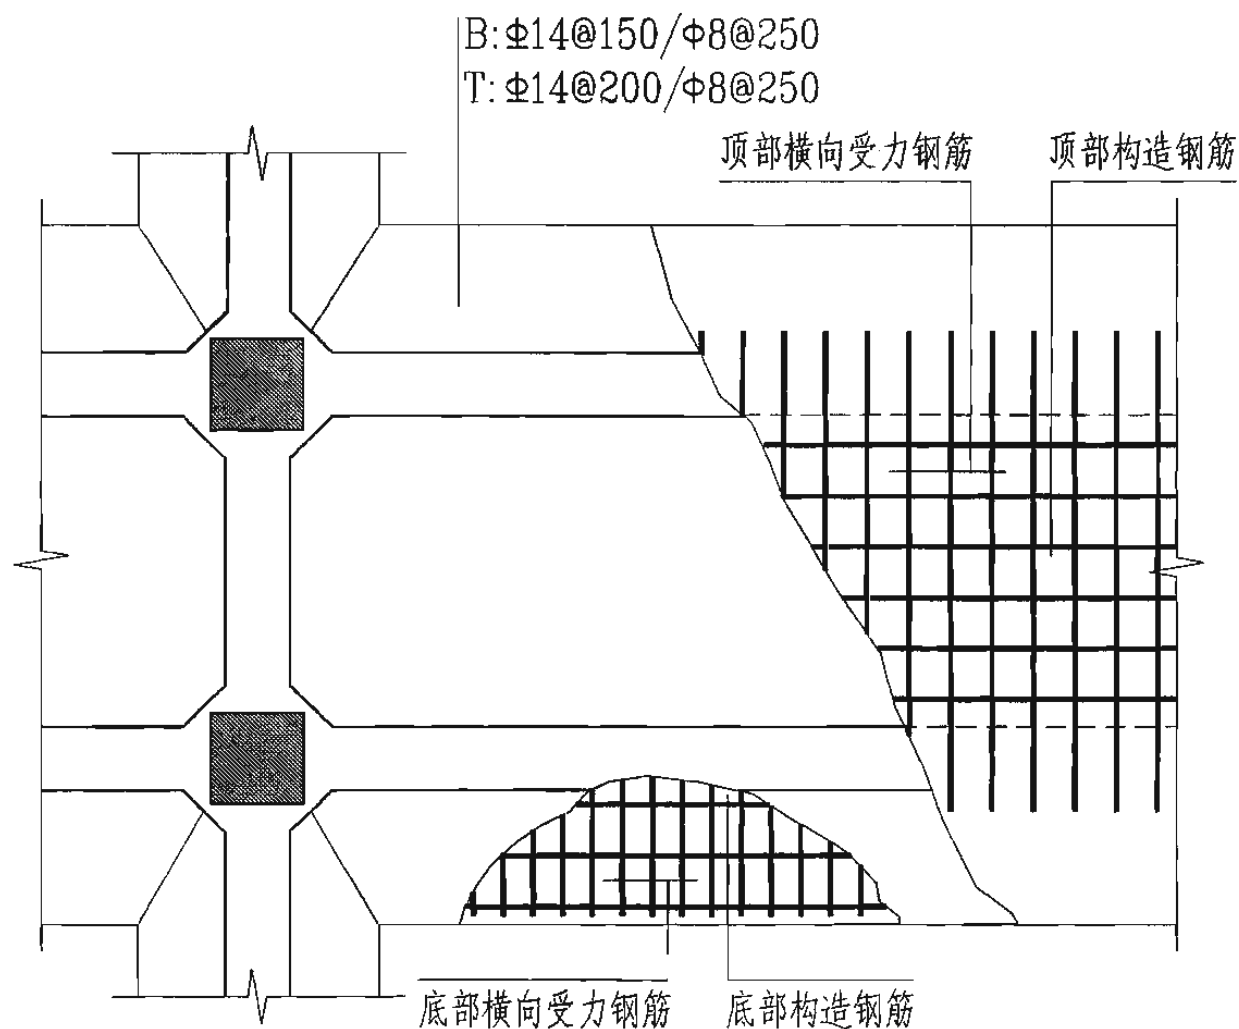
双梁条形基础底板顶部配筋示意
